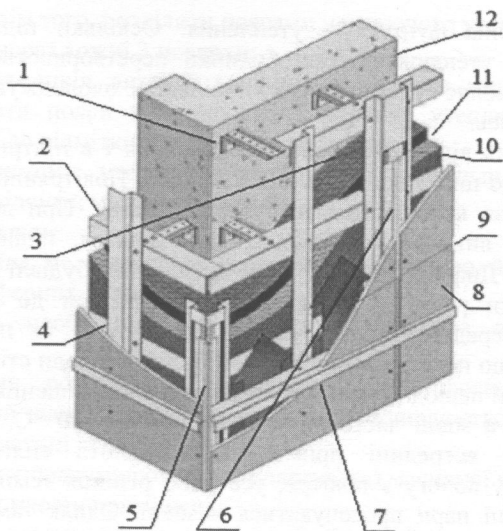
Конструкція вентилязованого фасаду:
